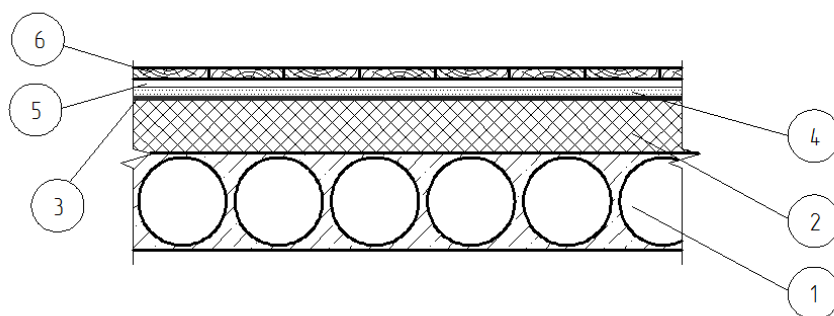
Схема до теплотехнічного розрахунку перекриття над підвалом:
